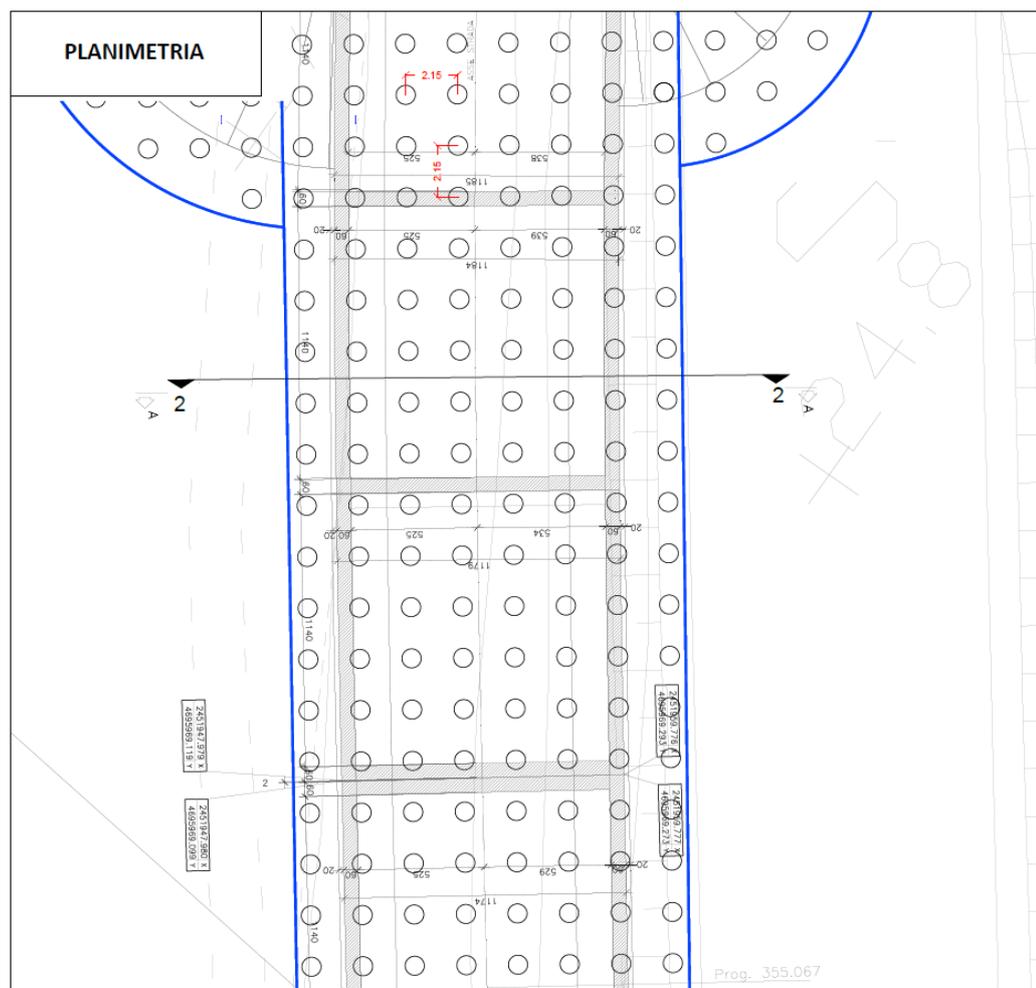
Sezione rappresentativa tratta IV01 - scatolare - planimetria
